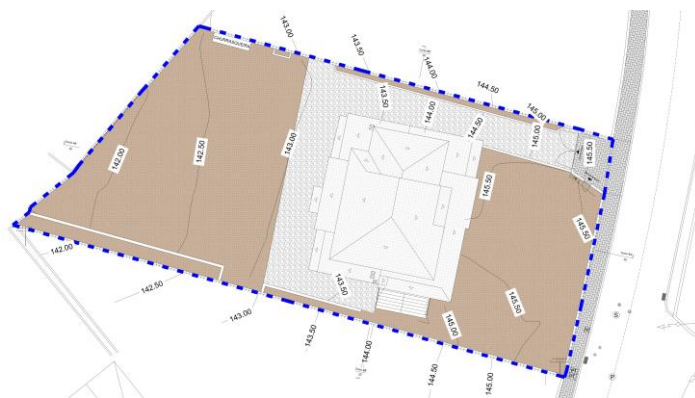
Existente - Planta da implantação sob levantamento topográfico. Fonte: Garq / Desenvolvimento: Autora.
